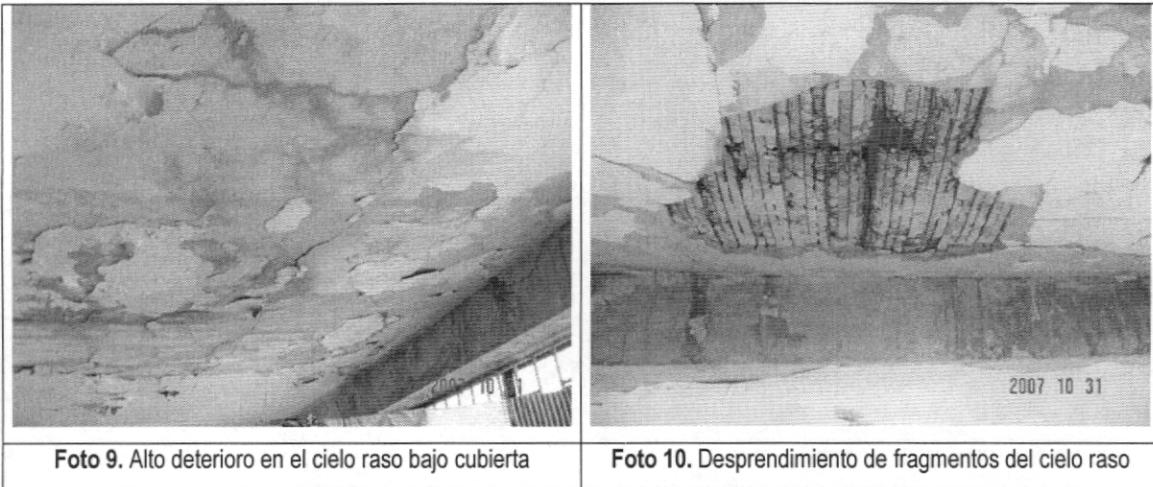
Alto deterioro en el cielo raso bajo cubierta
